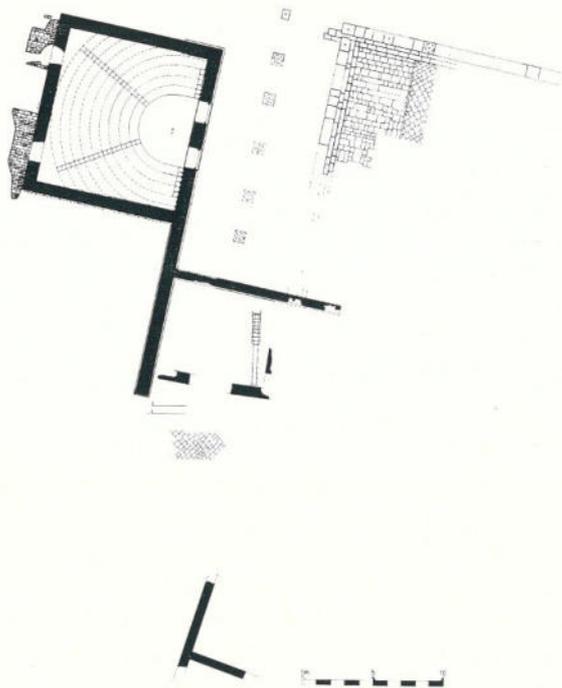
Pianta schematica del lato ovest dell'agorà.
